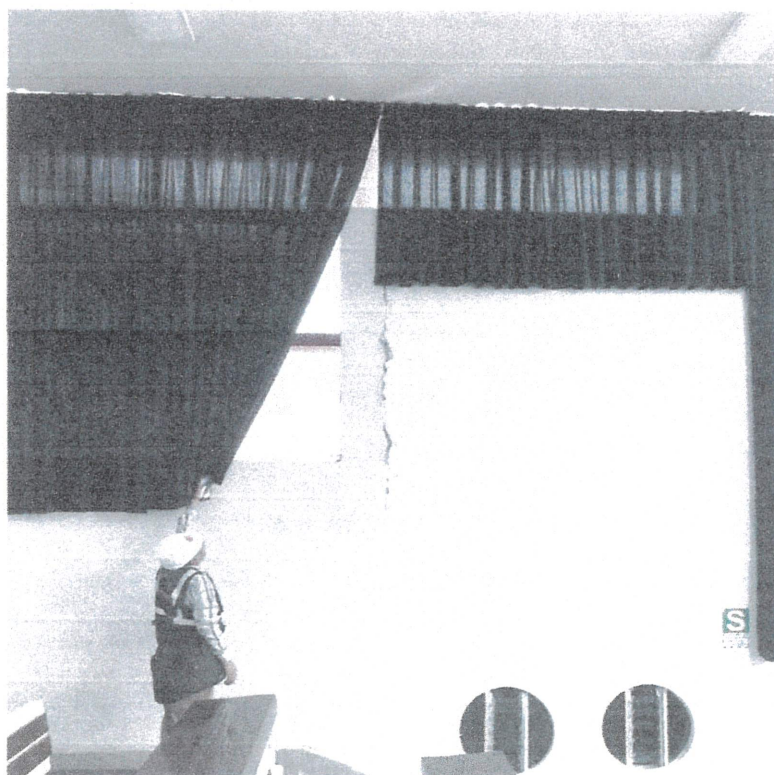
Presencia de fisuras verticales en los muros de albañilería
